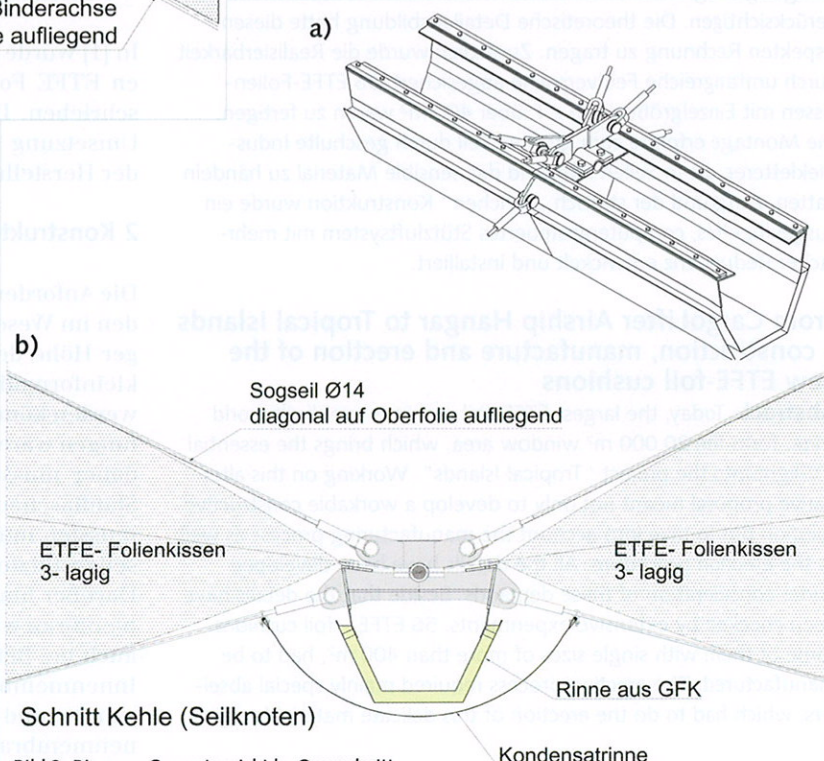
Rinne a- Gesamtansicht b- Querschnitt
